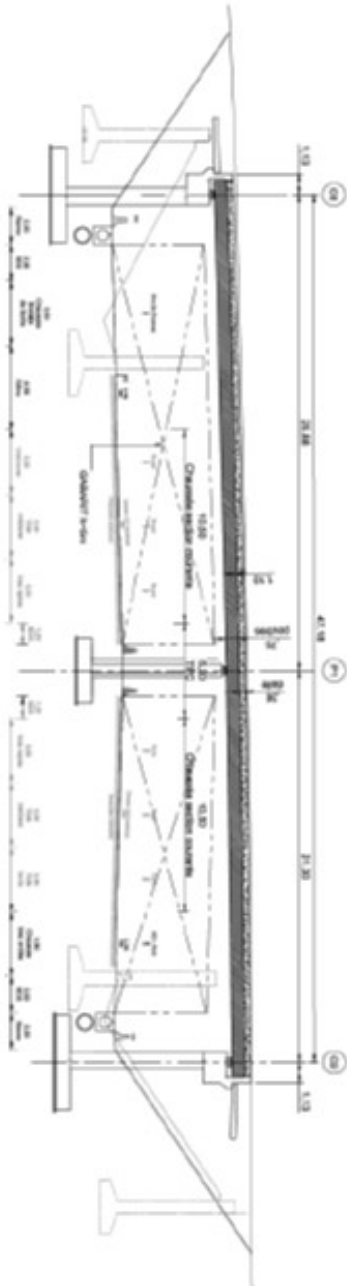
Profil en travers de la section courante sous l'ouvrage d'art
